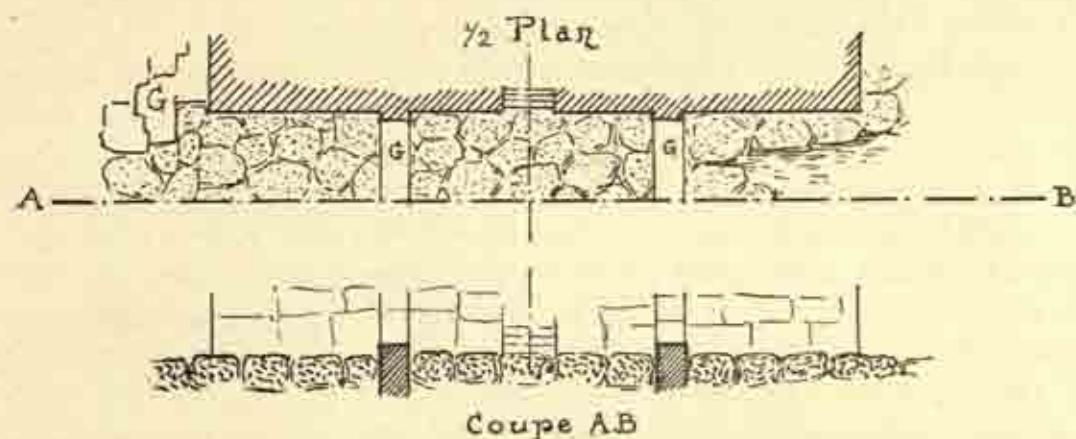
Plan et coupe sur le passage central de la porte Ouest de Ta Prohm.
